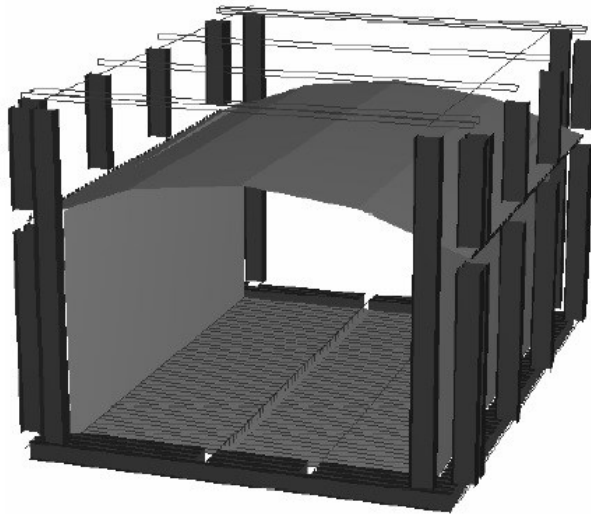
Просторова схема конструкції скловарної печі
